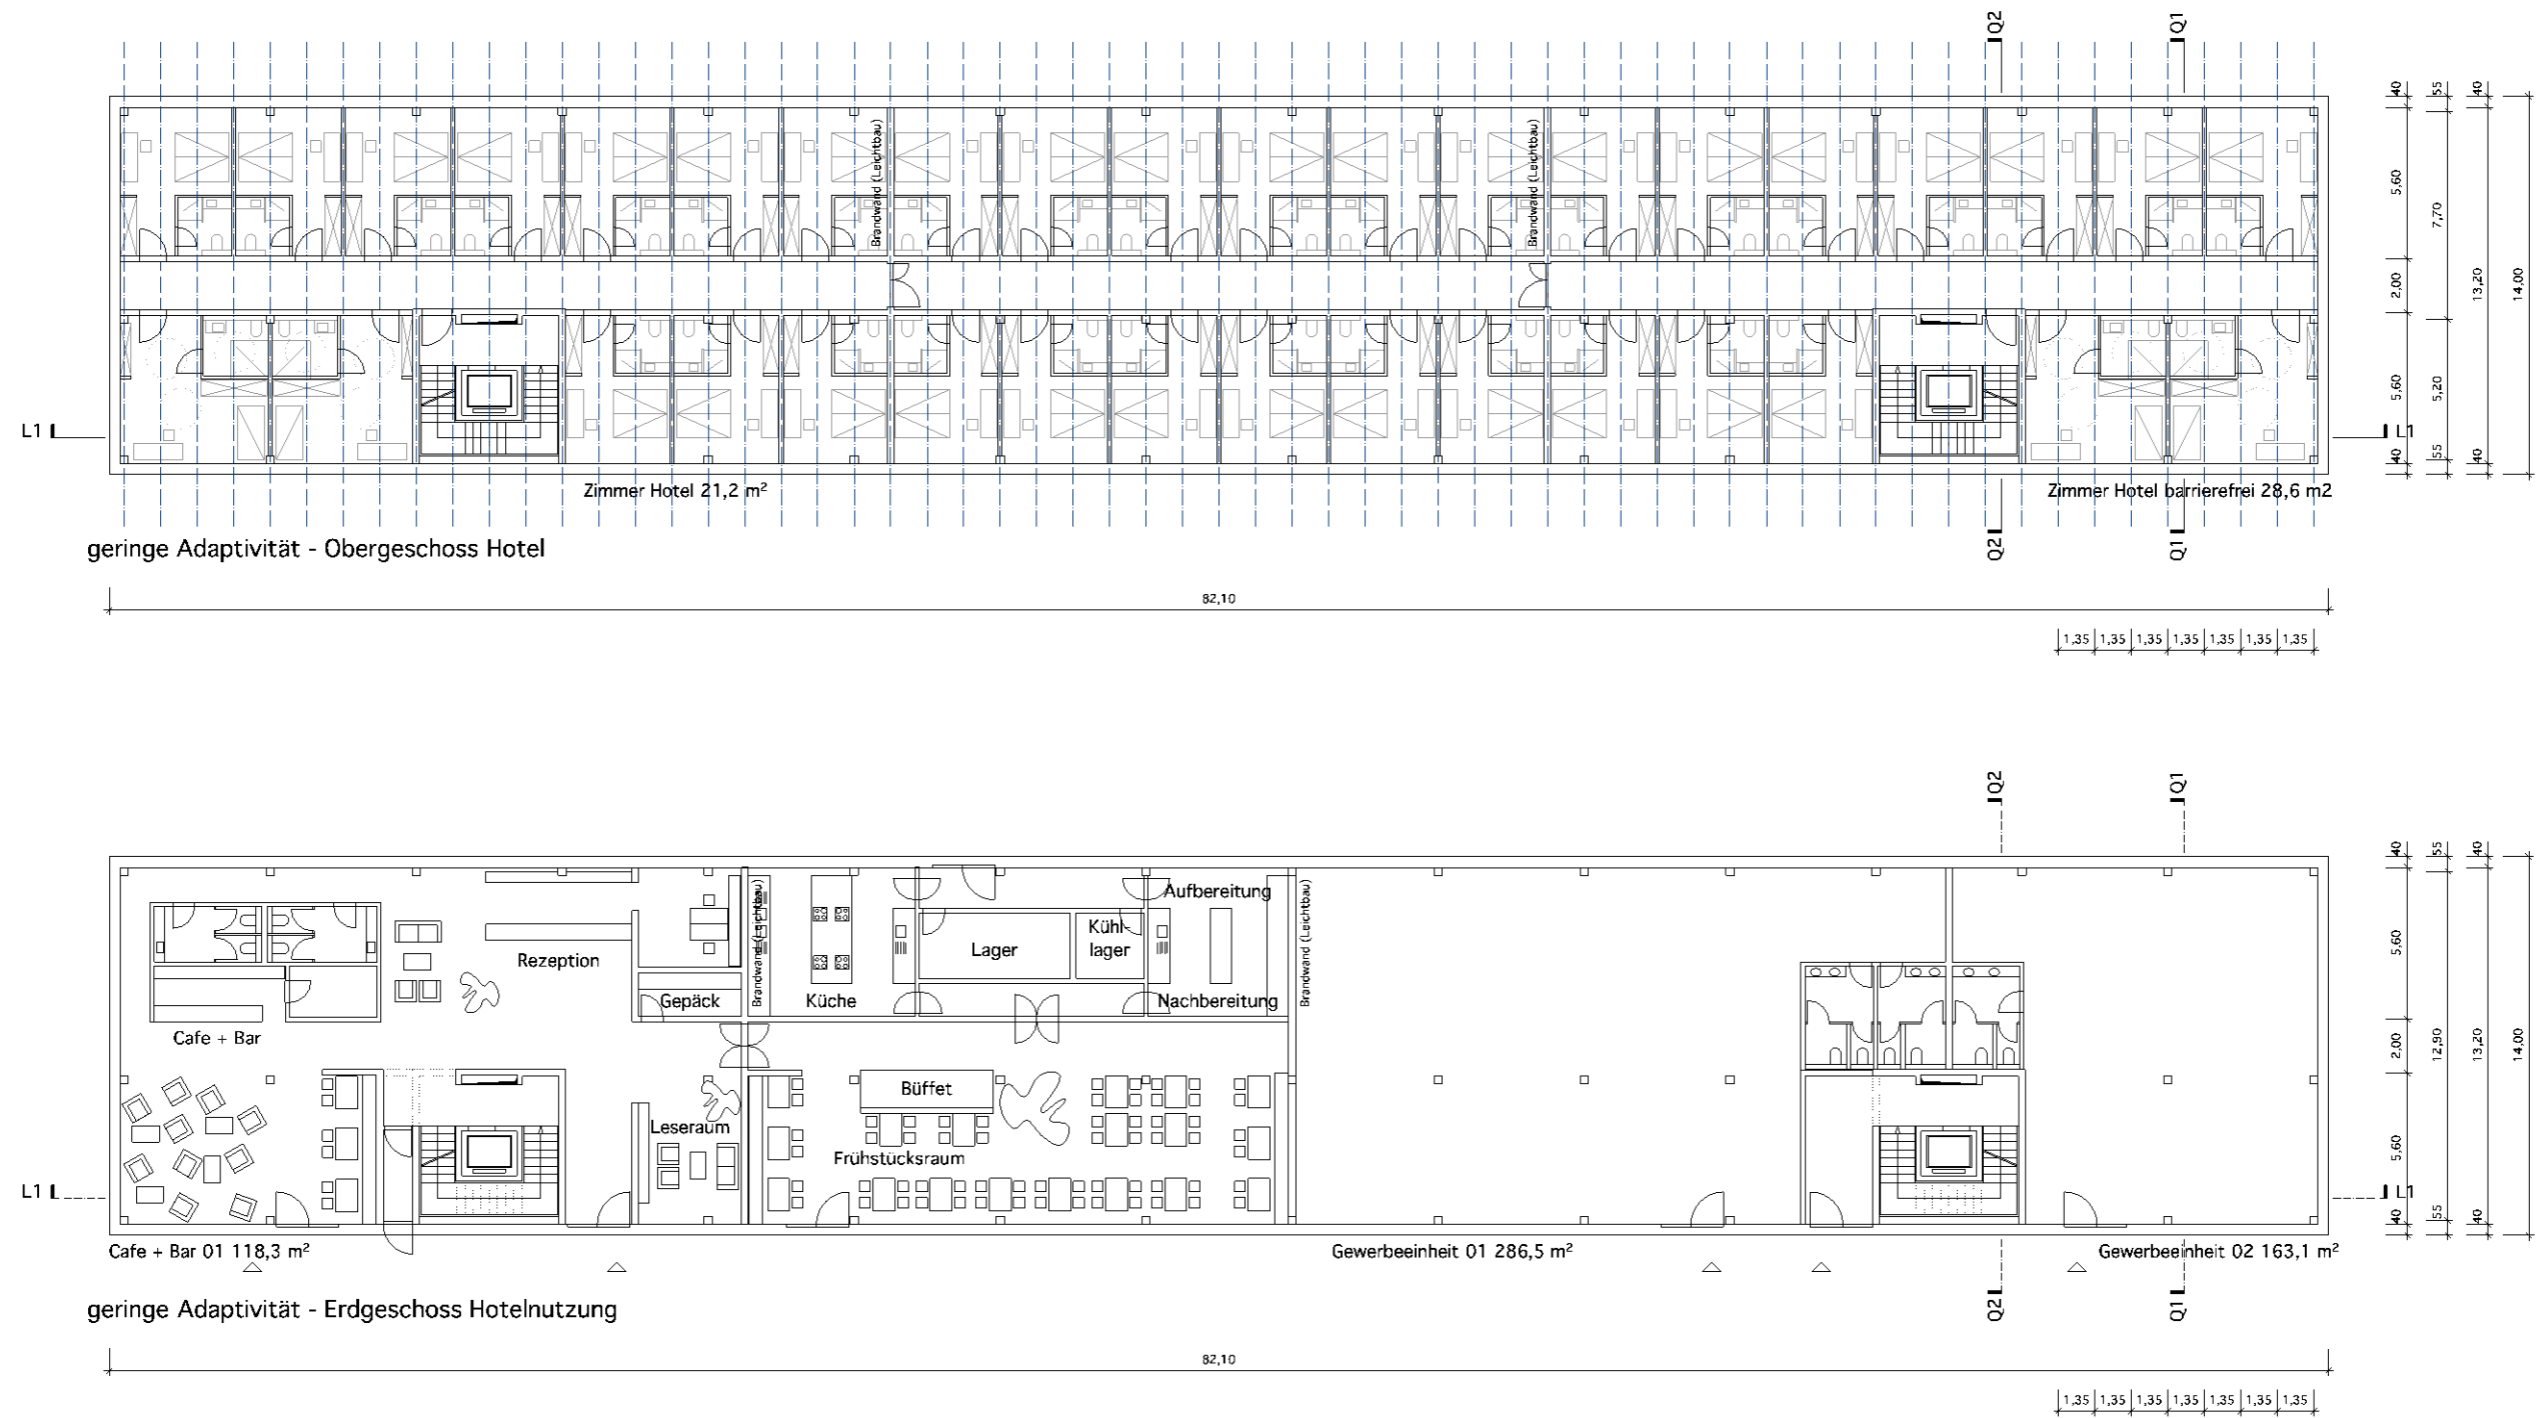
Grundrisse Obergeschoss (oben) und Erdgeschoss (unten) des Referenzgebäudes „geringe Adaptivität“ für eine Hotelnutzung
